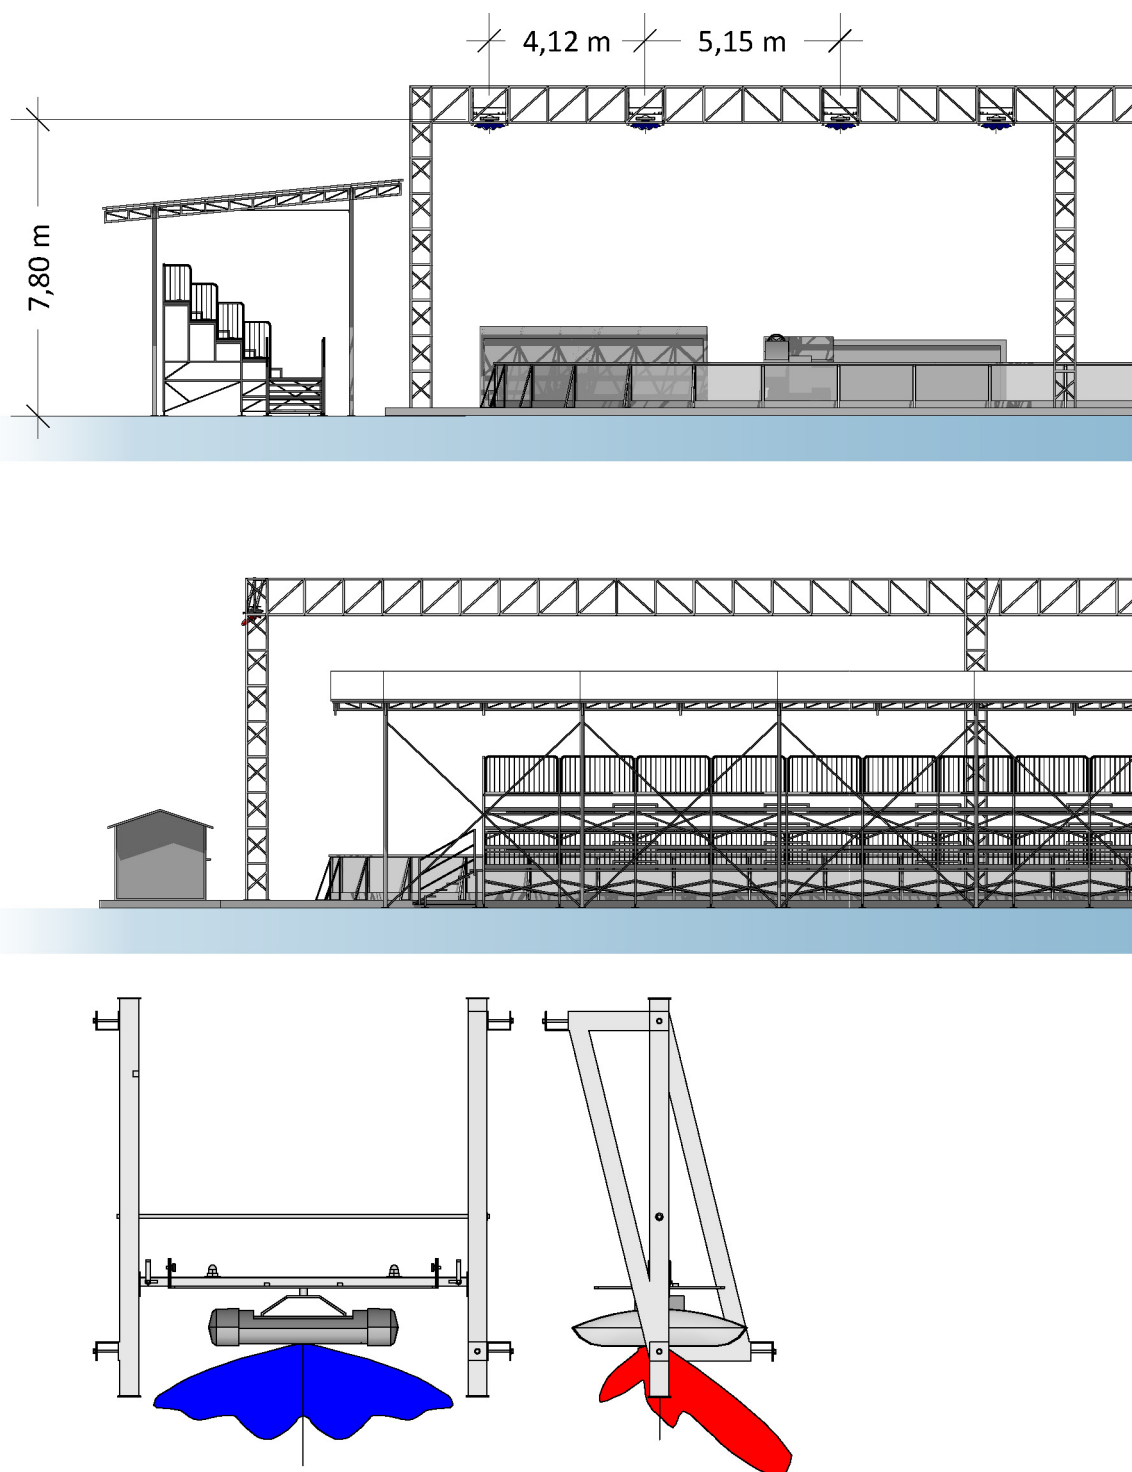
installazione degli apparecchi a Led per l'illuminazione dell'area di ingresso. Prospetti laterale e frontale in scala 1:200 e prospetti dell'apparecchio con curva di diffusione luminosa in scala 1:20
